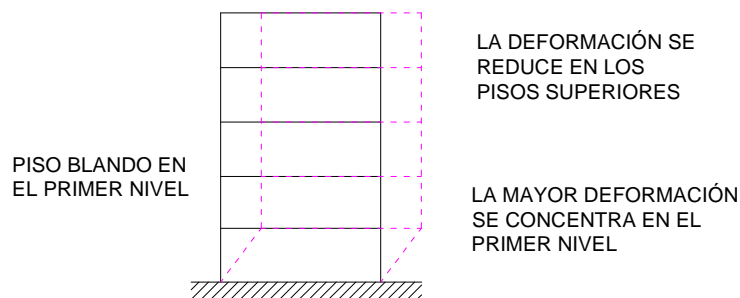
Sistema de piso blando (planta baja flexible) con deformaciones controladas
